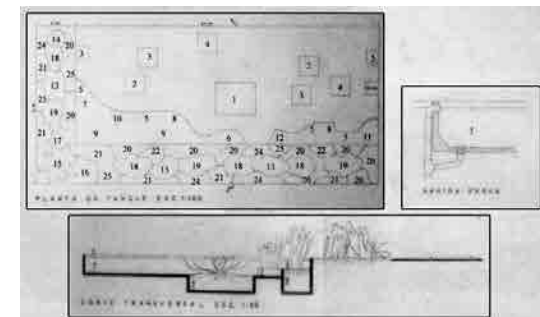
Detalles constructivos del lago en la plaza de la primera propuesta para el Ministerio.
